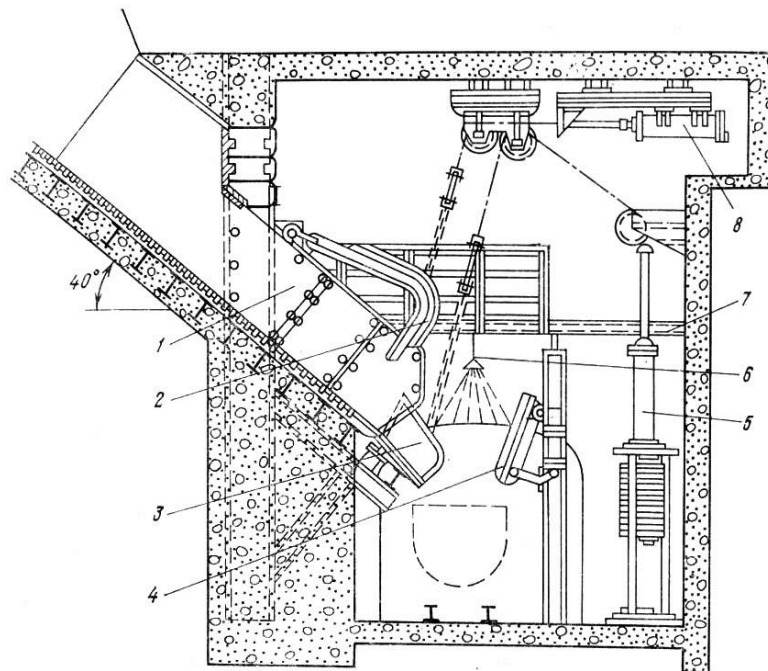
Люковий навантажувальний пункт: 1 – теча; 2 – пальці; 3 – фартух; 4 – відбійний щит; 5 – пневмопривід фартуха; 6 – пристрій для зрошення; 7 – площадка оператора; 8 – пневмопривід пальцевого затвора
